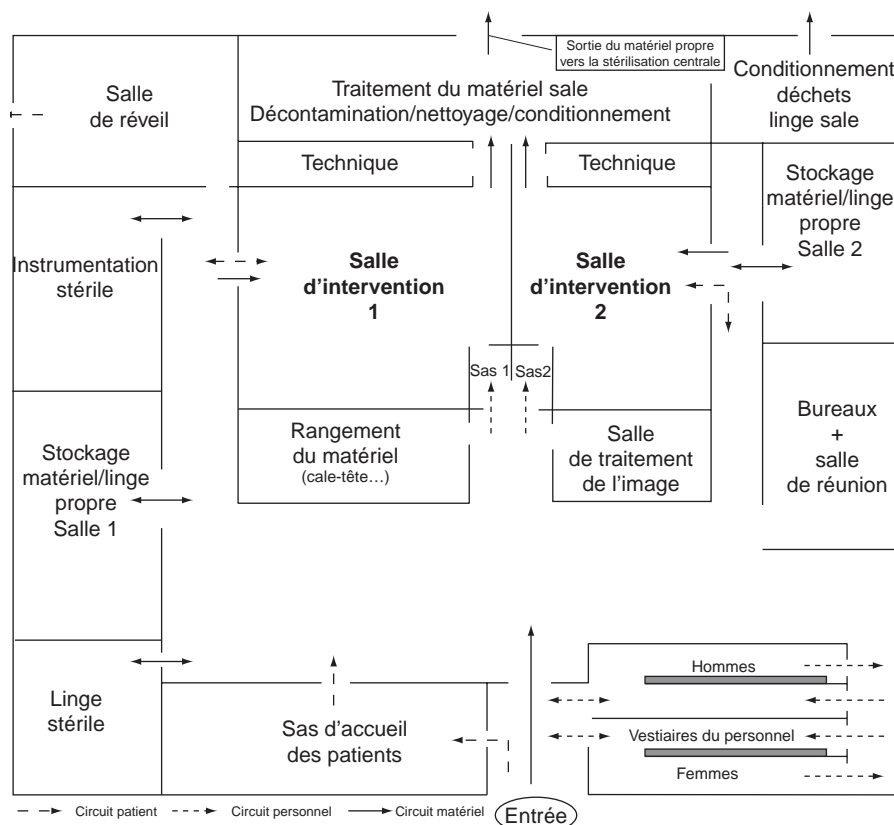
Plan-type d'un secteur de radiologie interventionnelle.
